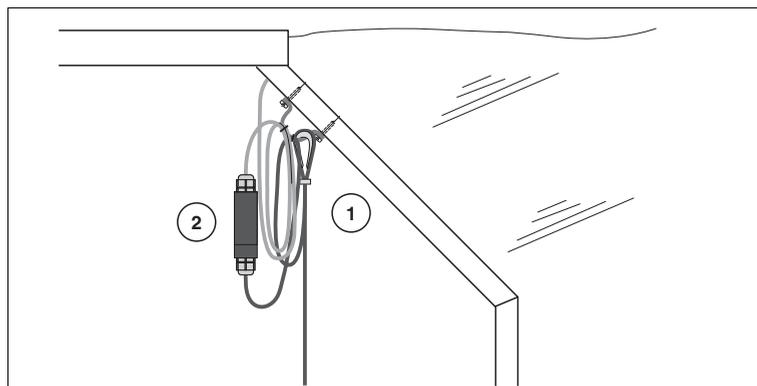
Montage avec connecteur de câble et kit de fixation
